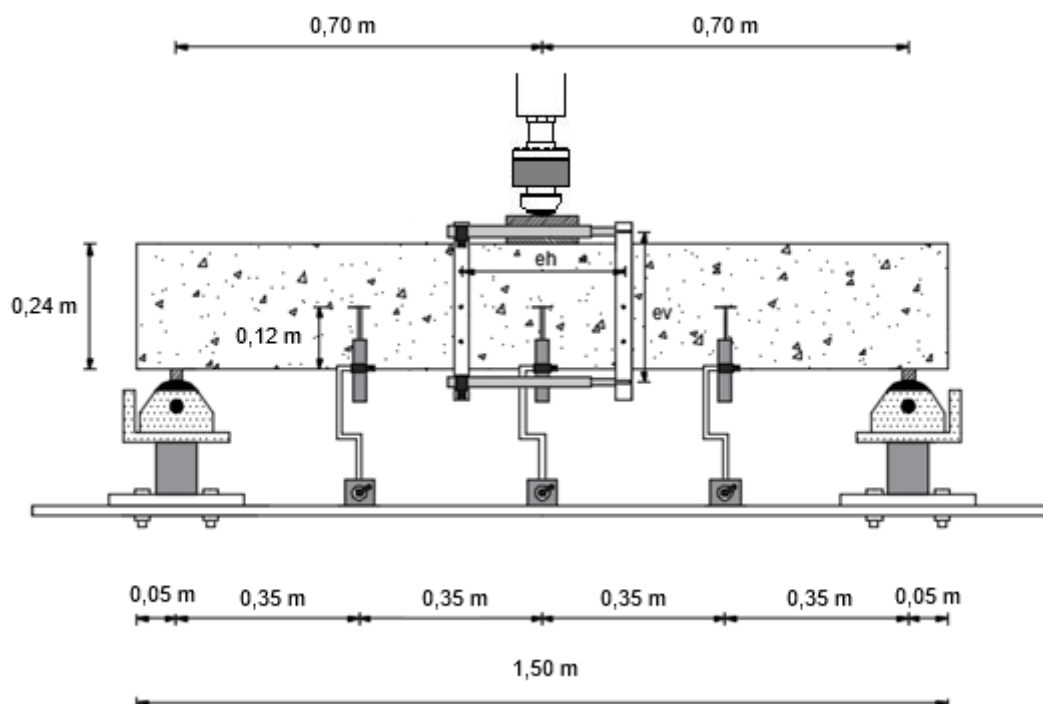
Esquema detalhado do equipamento de ensaio (Saldanha *et al*, 2012)
